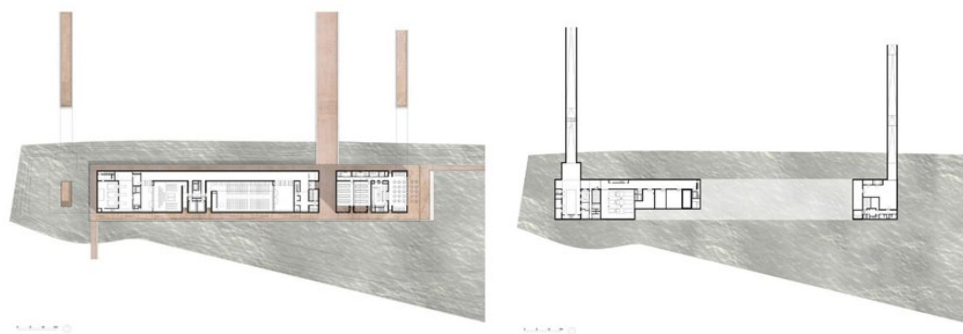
План 1-го и 2-го этажа крематория «Crematorium Hofheide». Фото© RCR Architectes
